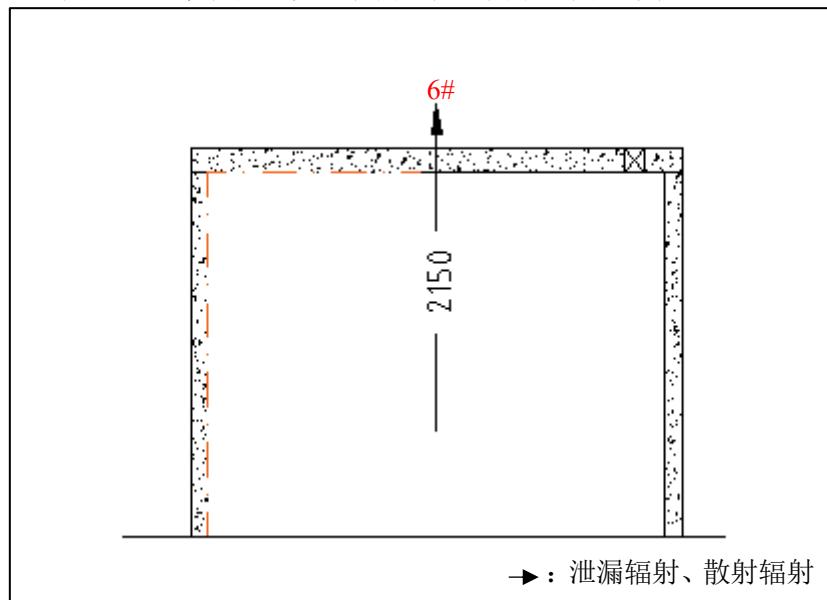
本项目探伤室预测点位剖面示意图（单位：mm）
